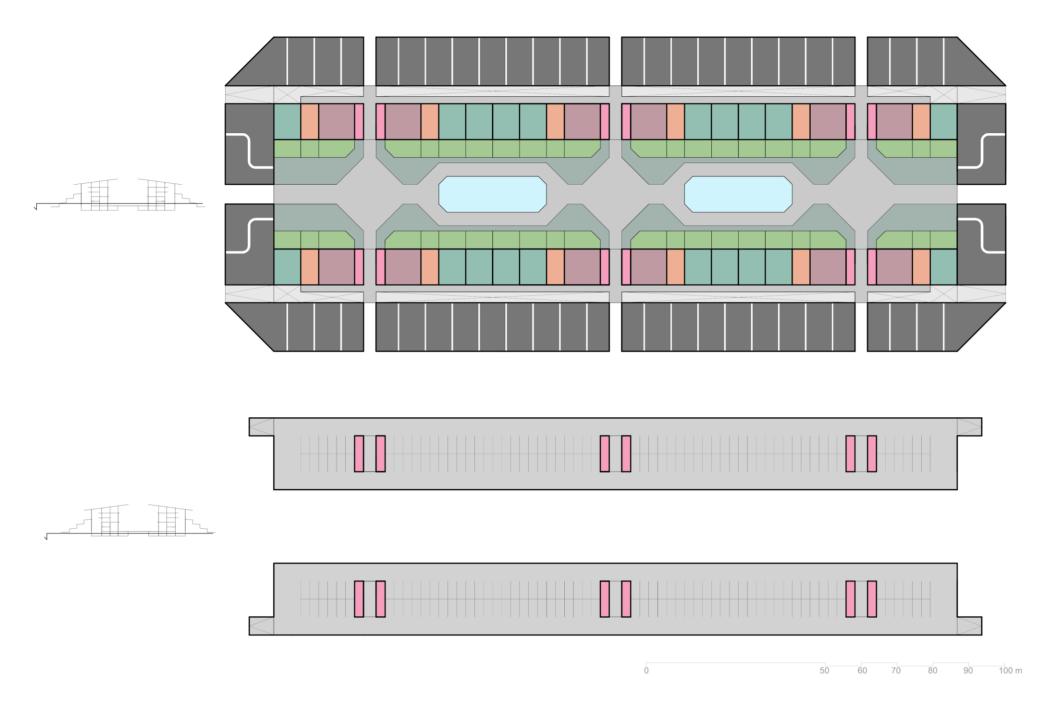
Planta desde la planta baja (arriba) y planta desde los aparcamientos situados bajo tierra (abajo)
